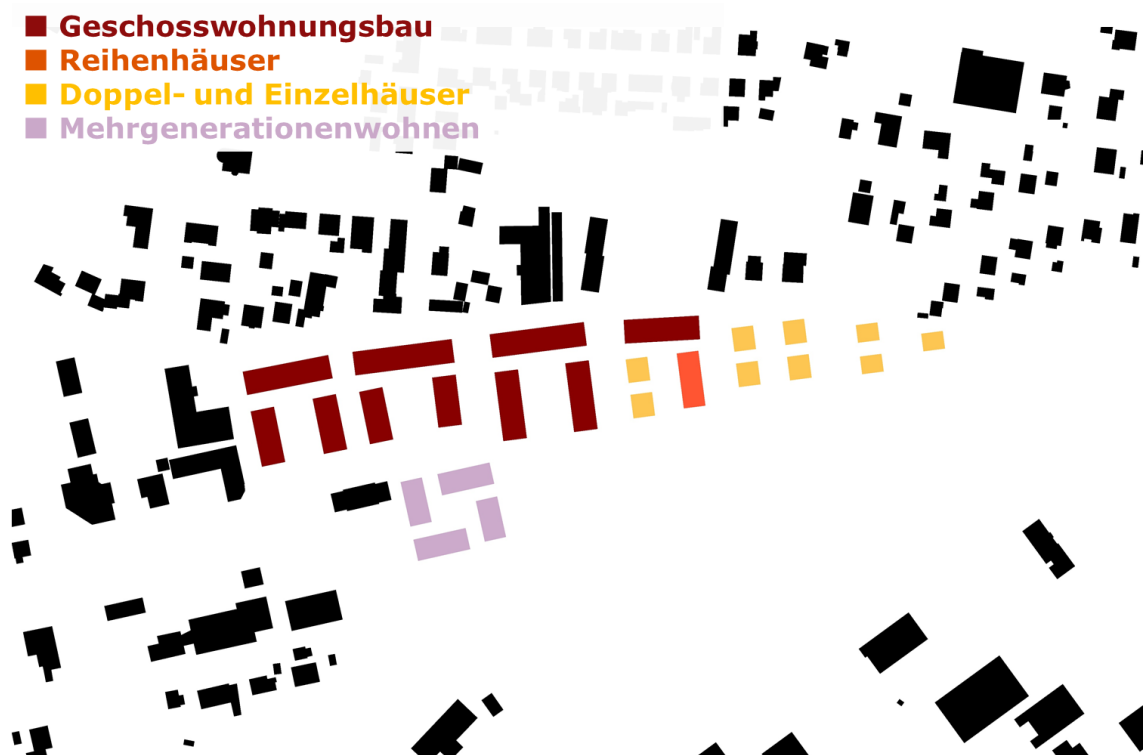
Schwarzplan mit der geplanten Bebauungsstruktur
